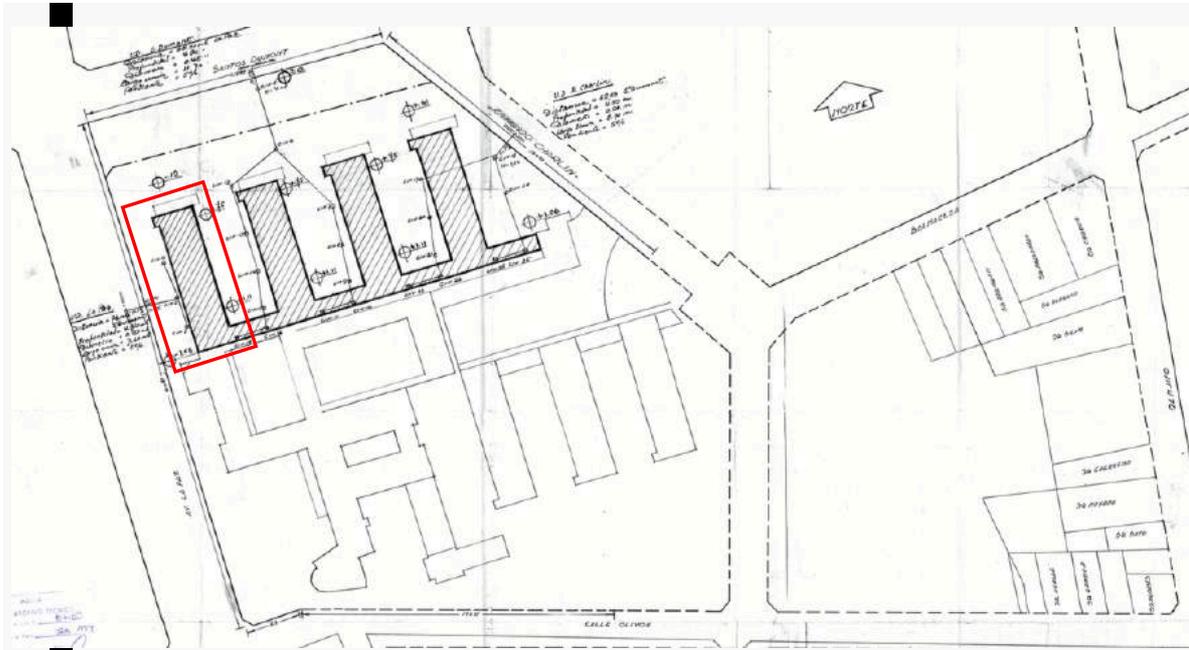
Fragmento plano de alcantarillado, aprobado en 1954. Se observa la silueta de los edificios tipo pabellón. En rojo se selecciona pabellón donde se aplica análisis gamma.
